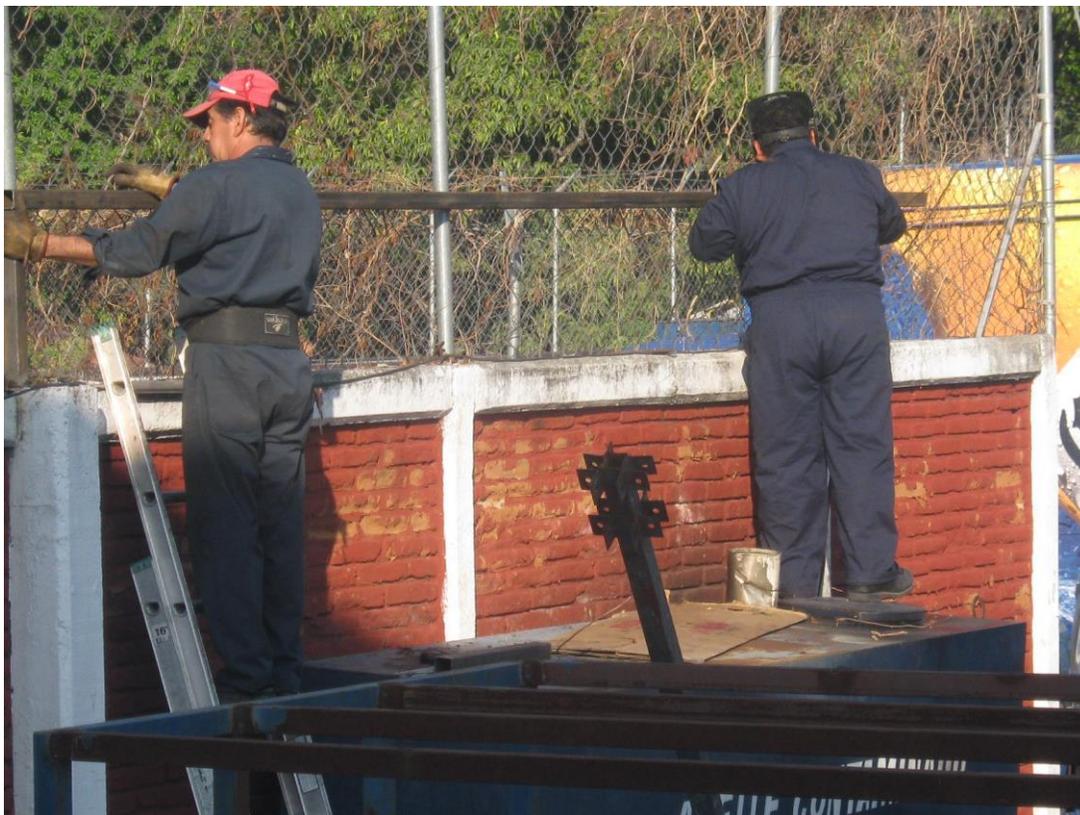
Trabajadores de la empresa, soldador y auxiliar instalado garita de aceites Contaminados.
